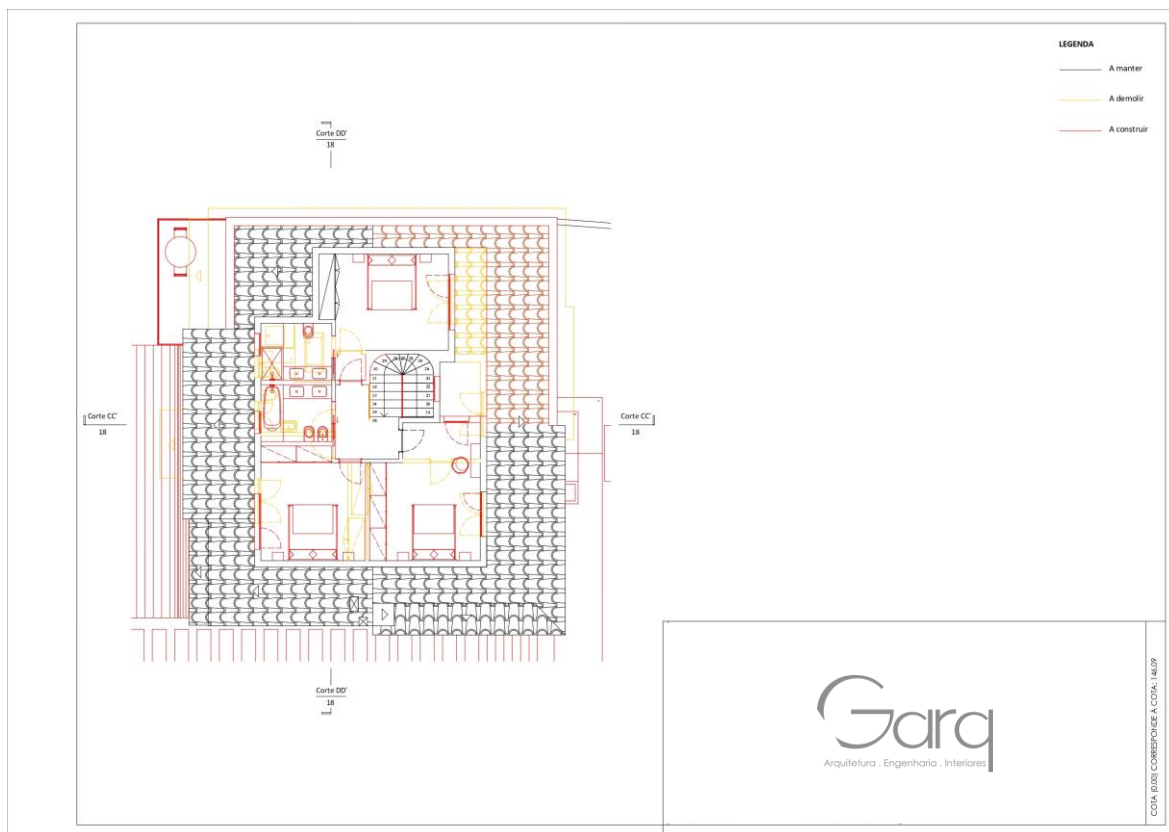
Vermelhos/Amarelos - Planta do piso 1 (LIC_R00). Fonte: Garq / Desenvolvimento: Autora.
